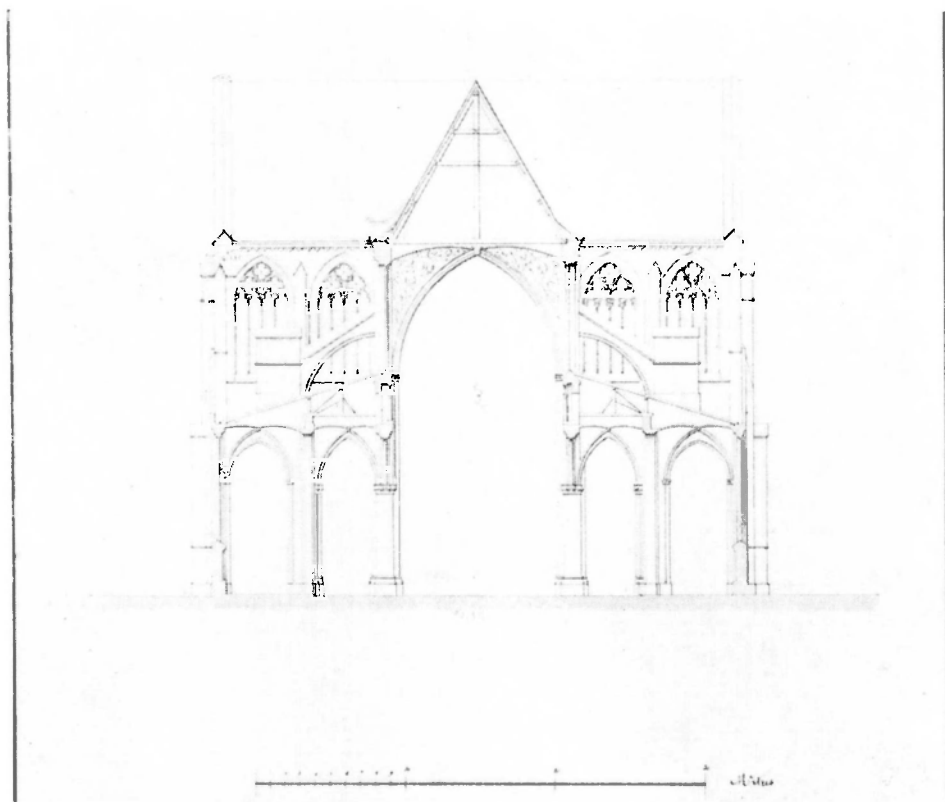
Coupe transversale sur la nef. Etat actuel en 1850.
